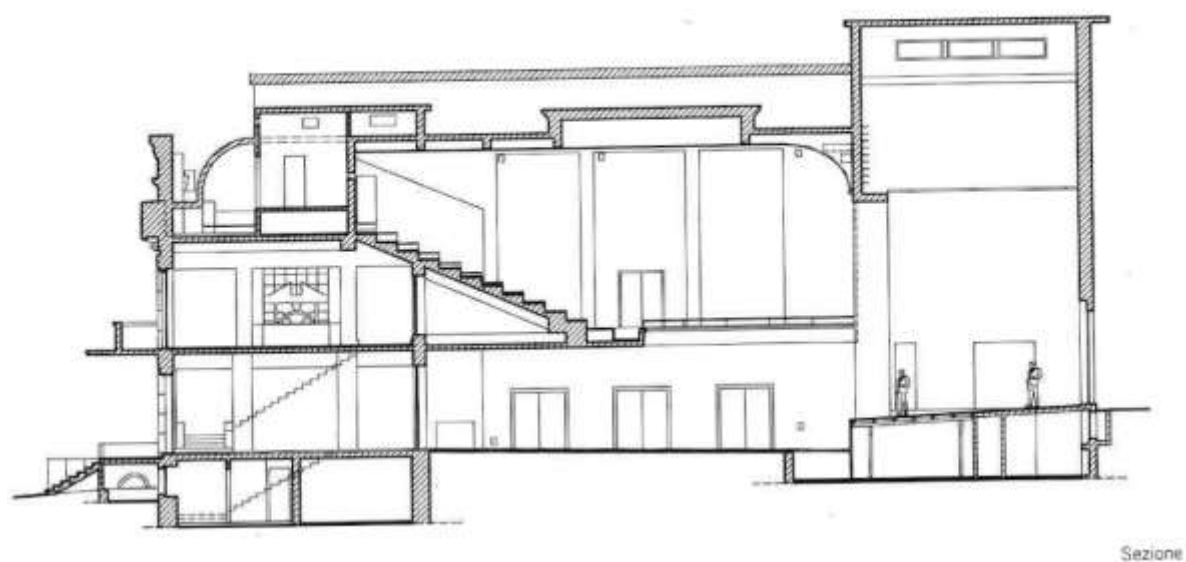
Façade principale et coupe longitudinale (OSSANNA CAVADINI, 2001).
